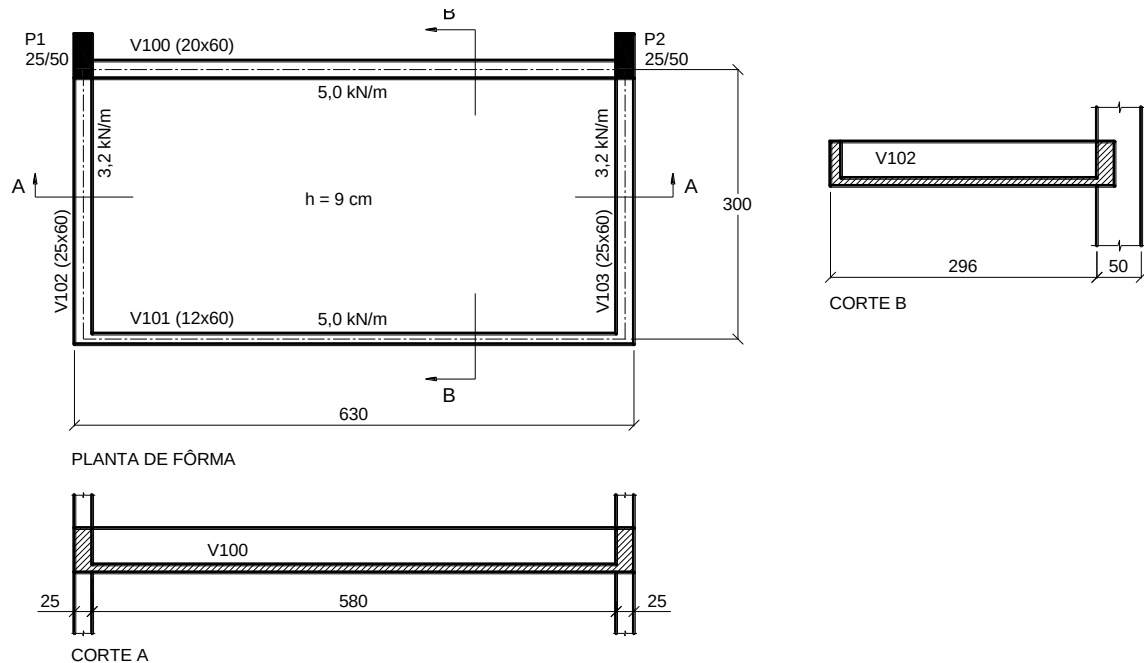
Planta de fôrma e cortes A e B (medidas em cm).
